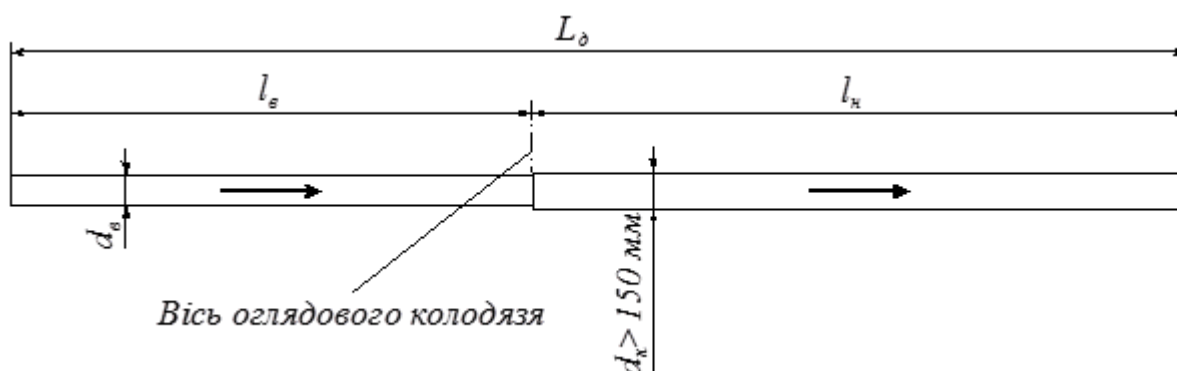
Схема ділянок дренажу з різними перерізами труб
